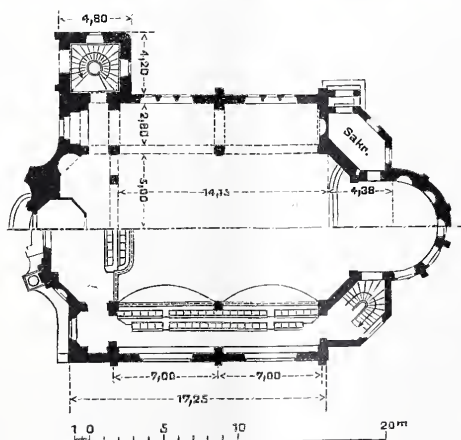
Grundrisse zu ebener Erde und in Emporenhöhe.
